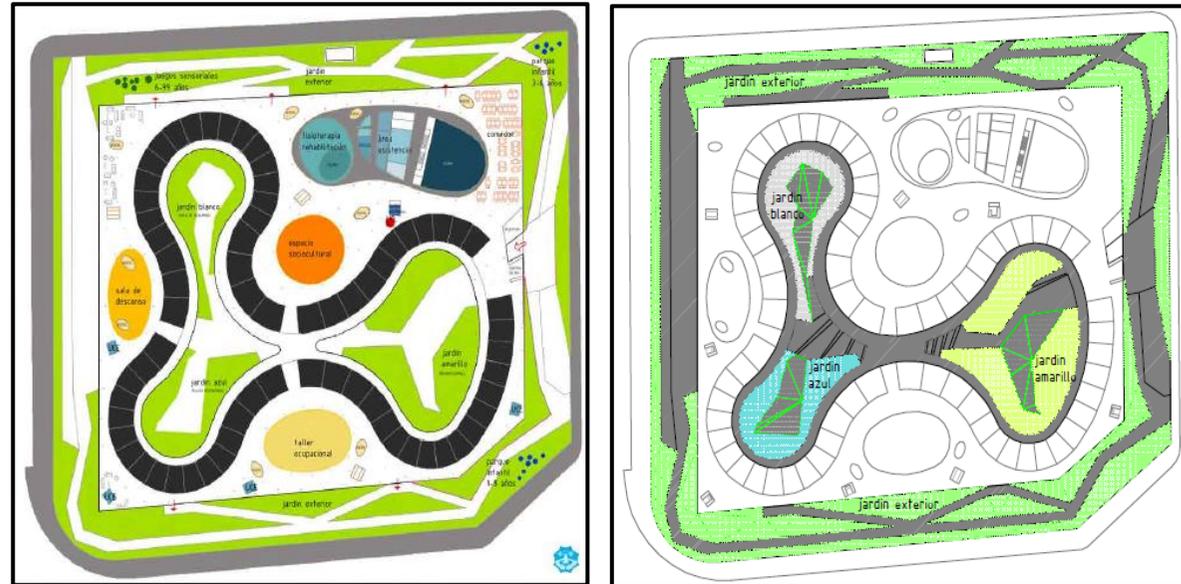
y 8. Planos zonificación interna y externa del proyecto
